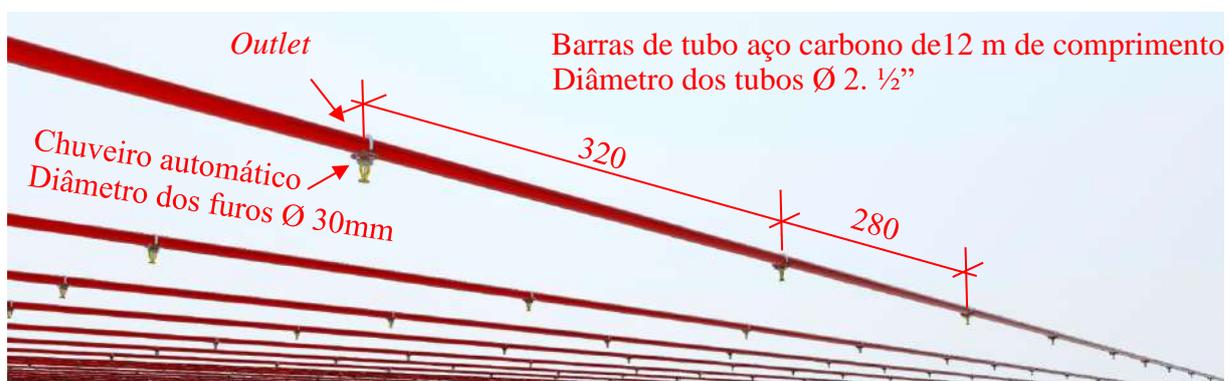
Detalhamento do ramal da rede de Sprinkler (Fonte: Barbieri, 2022 adaptado pela Autora)
